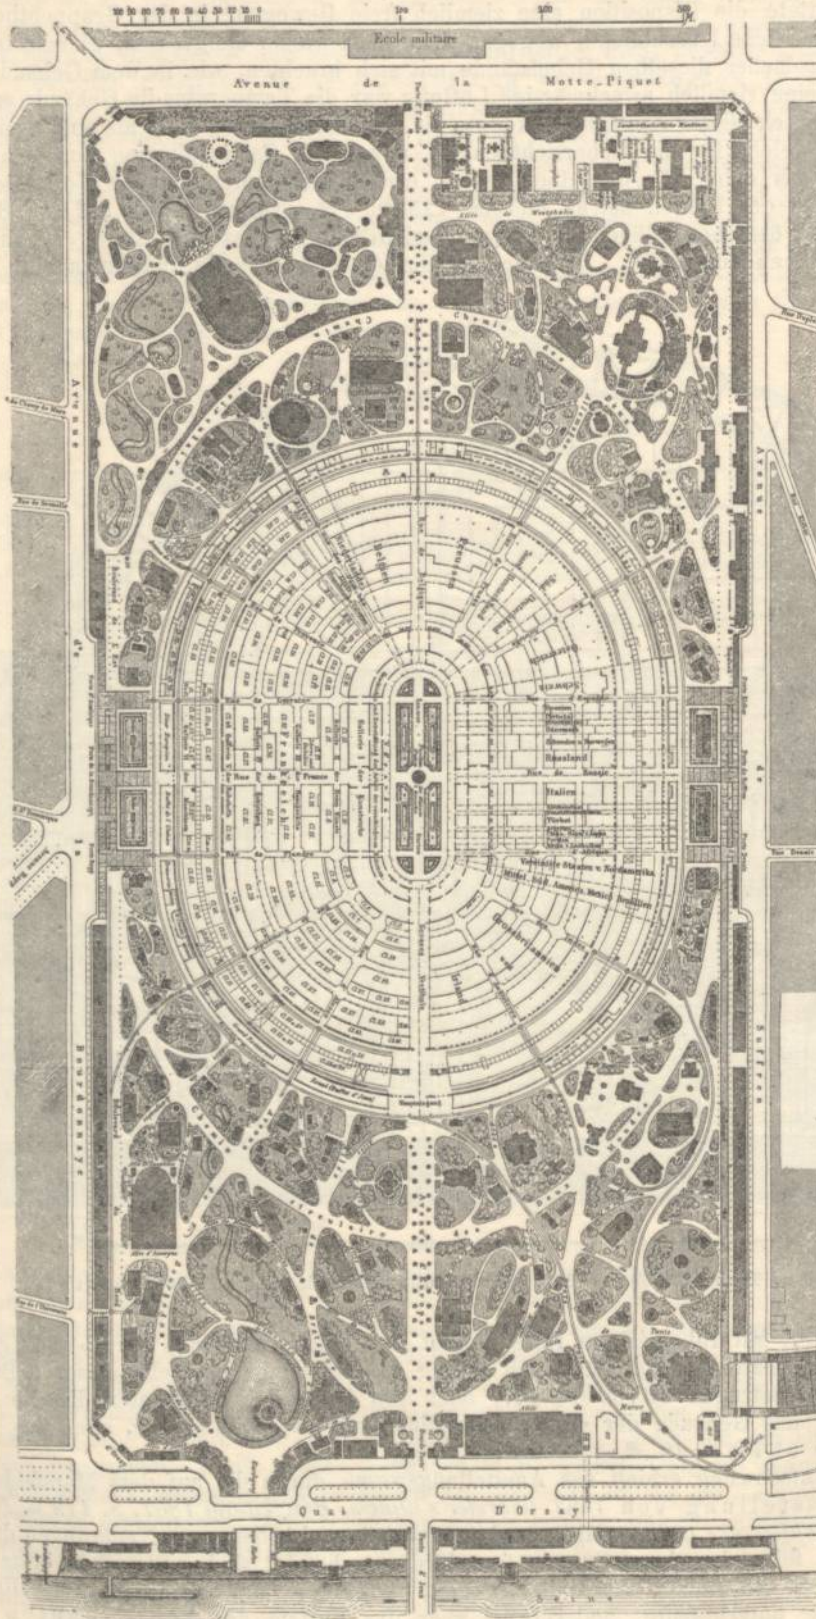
Ausstellungsgebäude in Paris 1867. Situationsplan mit Parkanlage.
